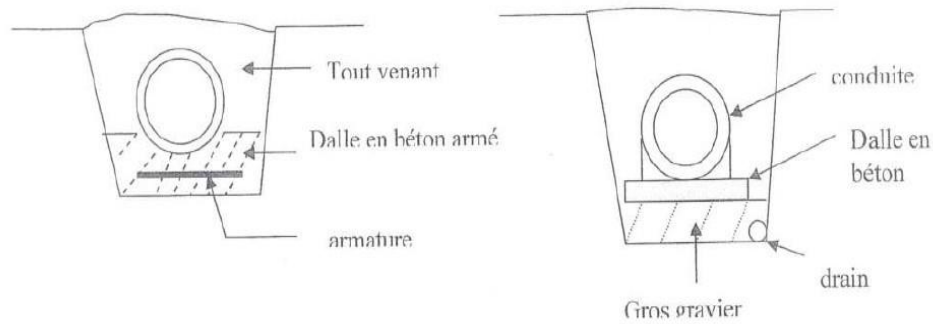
pose de conduite dans un terrain mouille (b. Saleh 2014)
